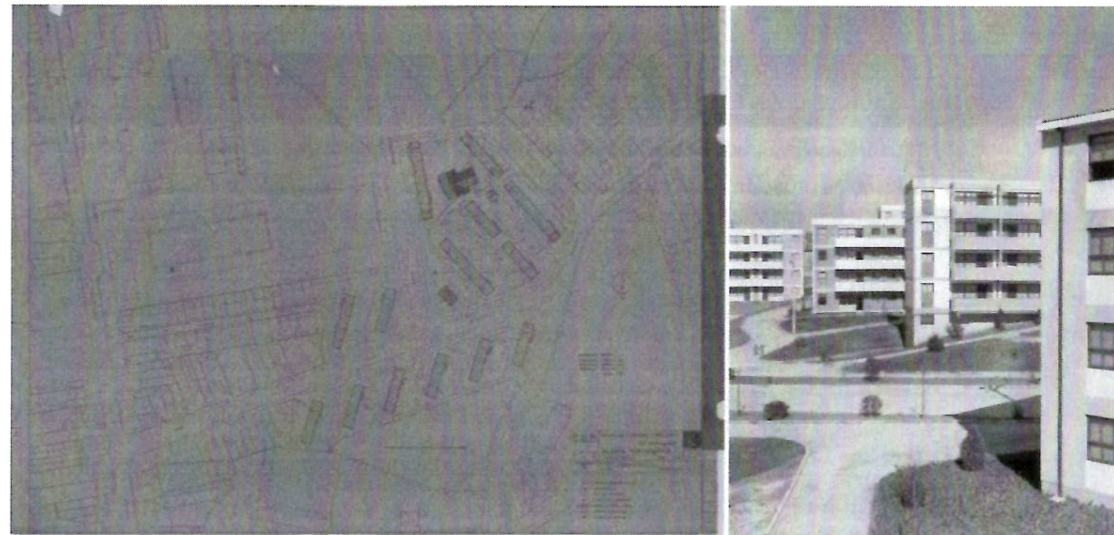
Plan de ubicación, 1956 (©archivos del municipio de Oporto)
